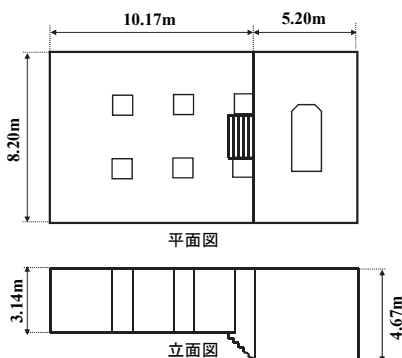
アメンヘテプ3世王墓埋葬室の平面図と立面図
